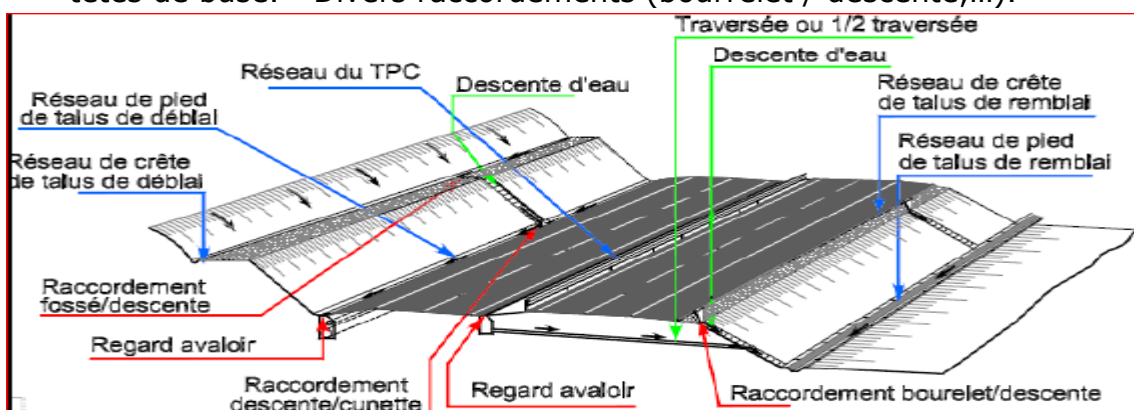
Situation des réseaux d'assainissement sur le profil en travers d'une route.[17]
